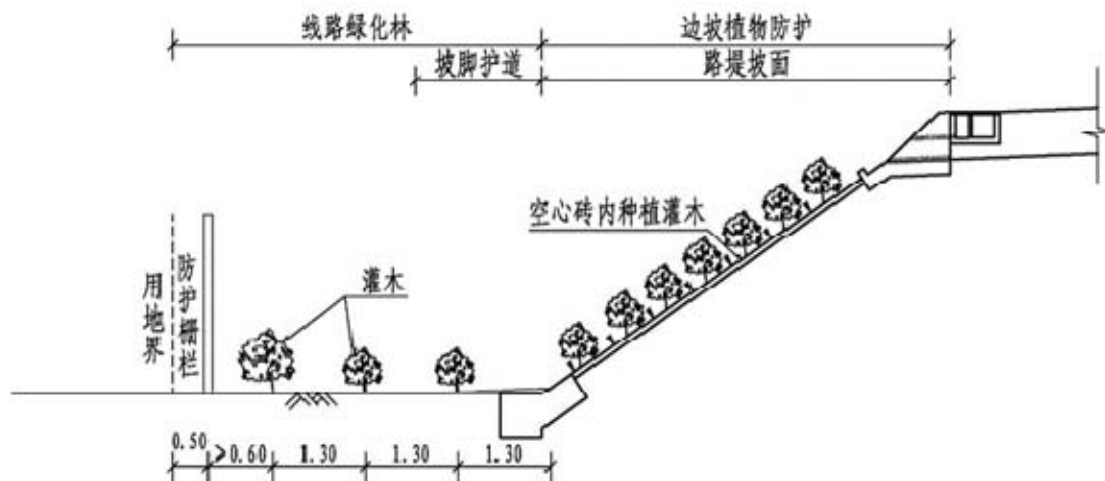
无排水沟路堤地段绿化断面示意图 (边坡高度<3m)
